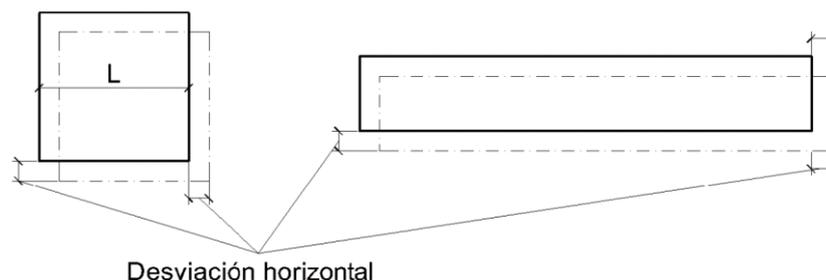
Vista en planta de la desviación horizontal permisible en la ubicación de columnas y muros.
